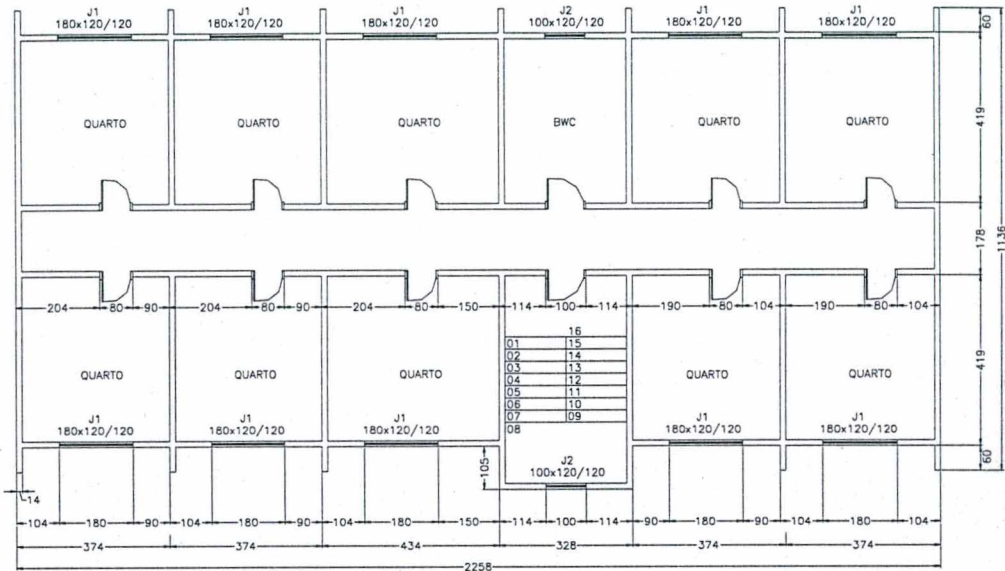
Planta baixa do pavimento tipo do edifício do exemplo 2
